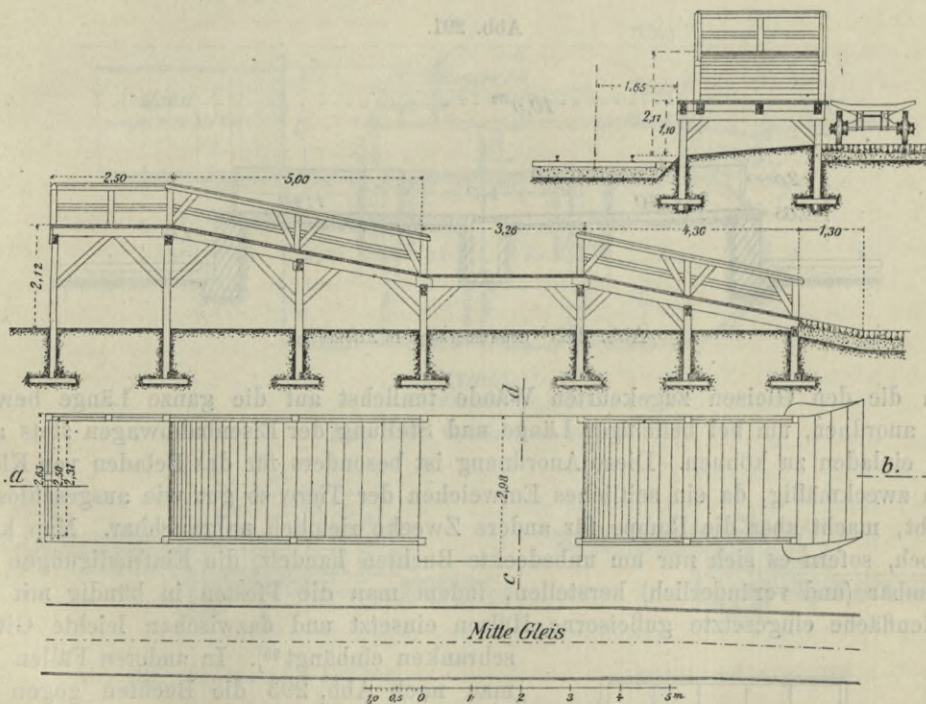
Zweigeschossige Rampe für geringen Verkehr.
